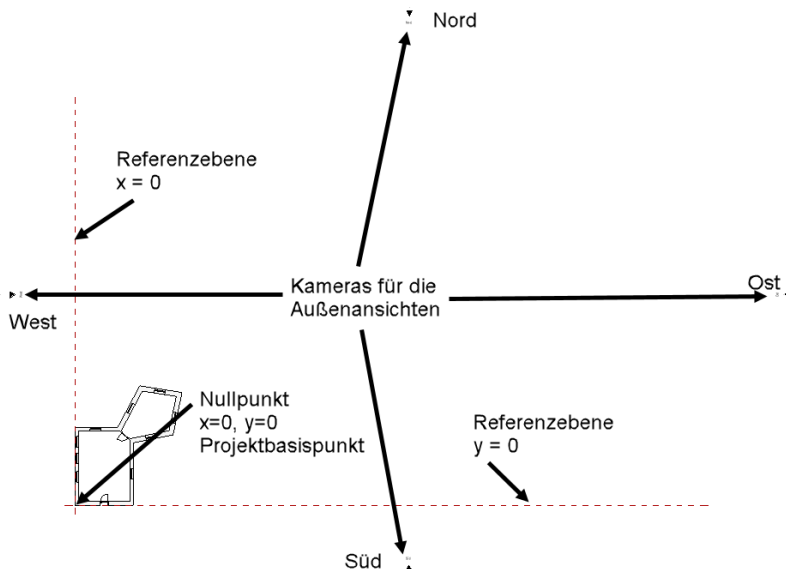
Zeichenfläche für 2D-Ansichten
